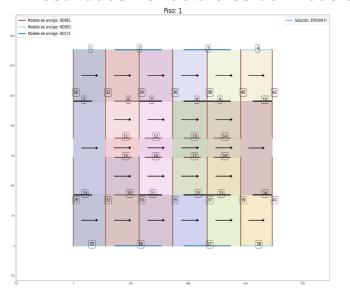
Resultados Elección de : 1) Solución constructiva de losa, panelización y dirección de envigado . 2) Muros de Corte 3)Anclajes
